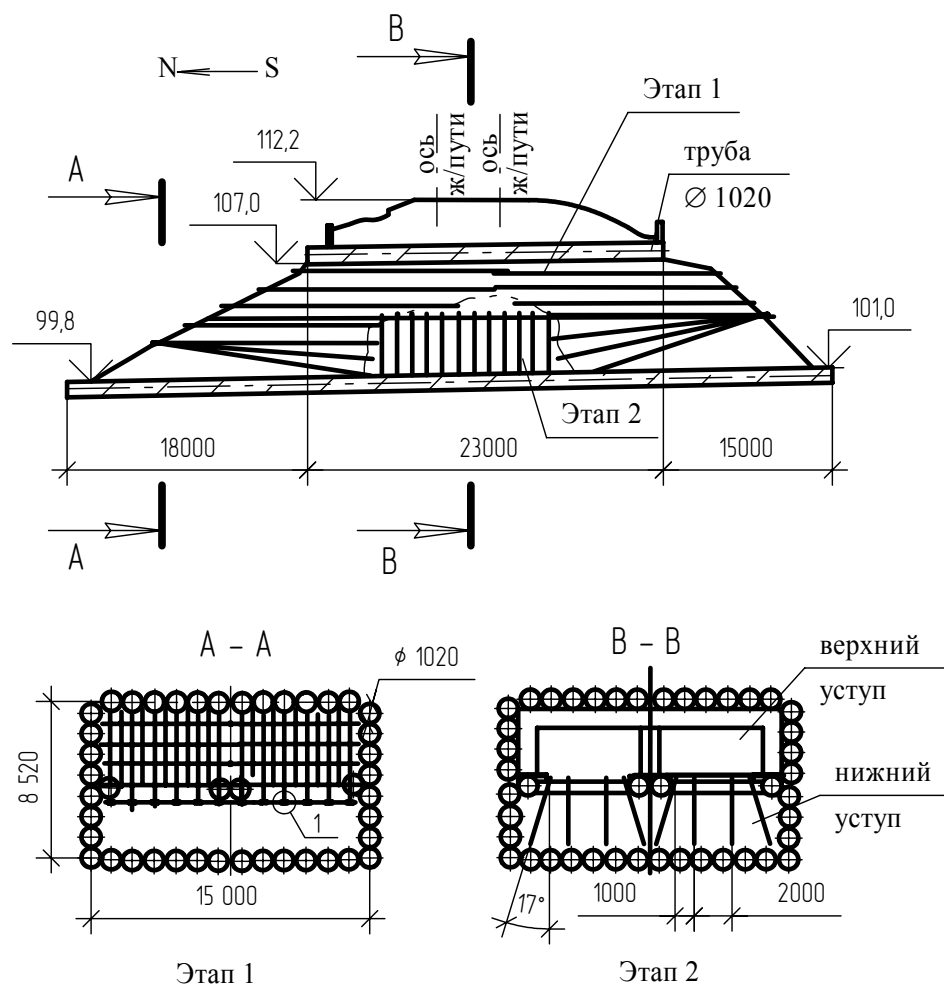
Схема инъекционного закрепления грунта в теле тоннеля.
